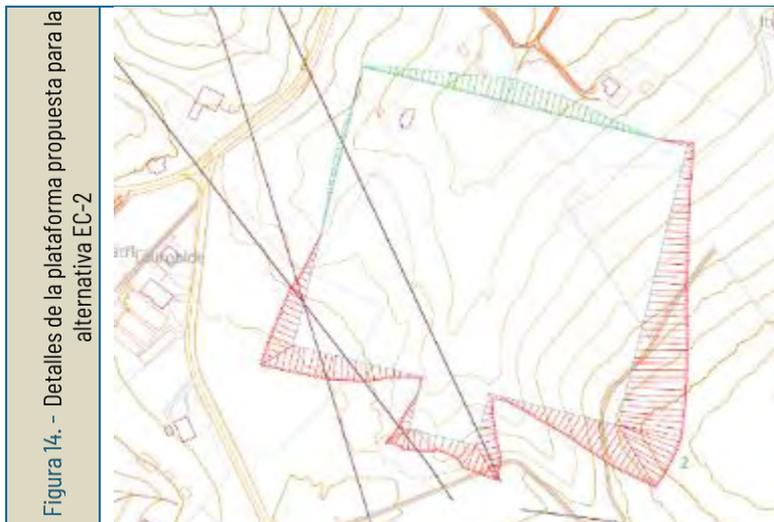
Detalles de la plataforma propuesta para la alternativa EC-2
